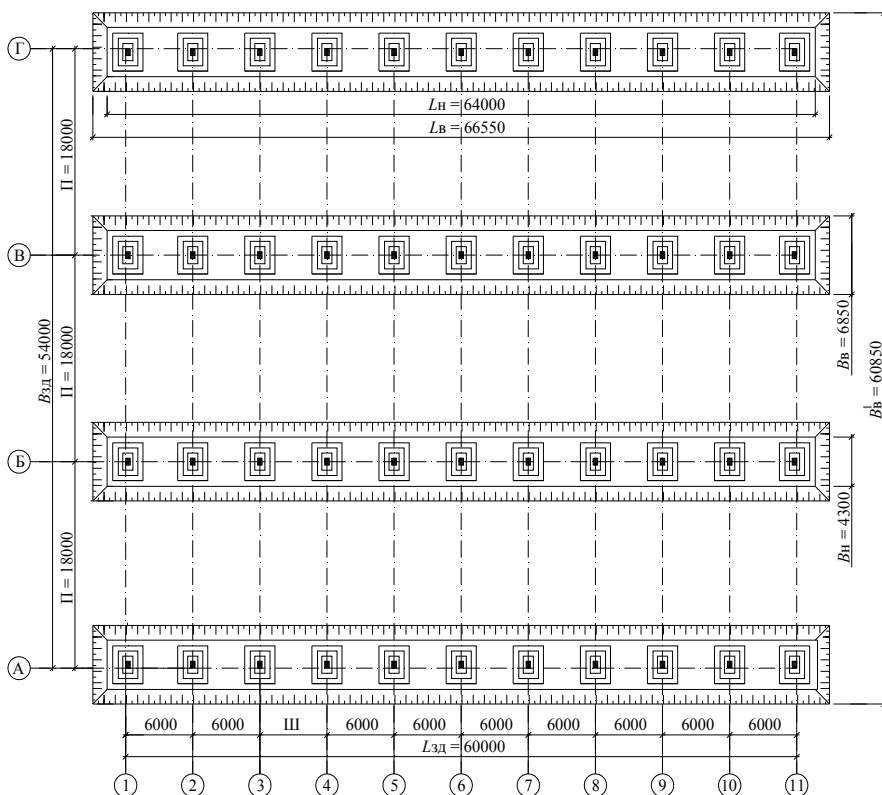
Общий вид траншей для возведения фундаментов под каждый ряд колонн
